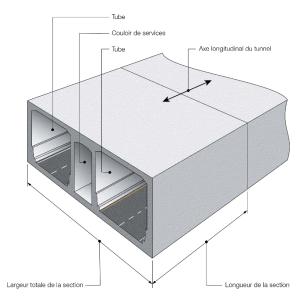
Largeur totale d'une section de tunnel constituée de plusieurs tubes
